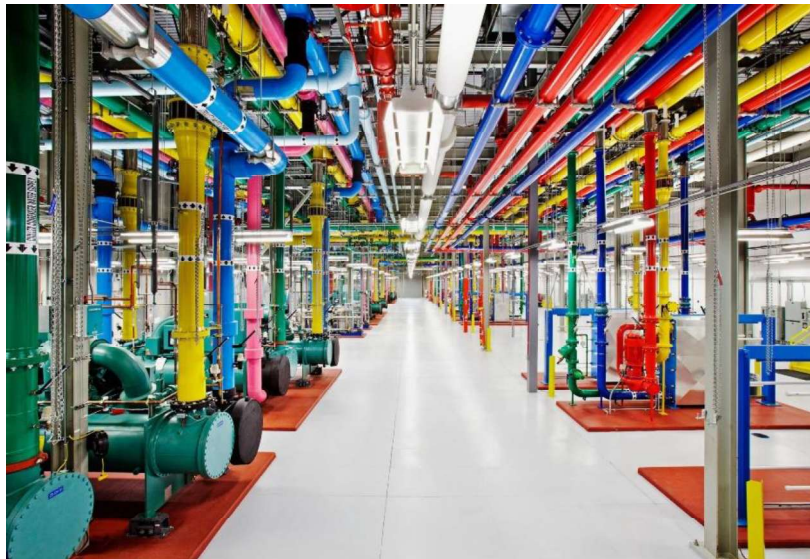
Exemplo de cores das tubulações em planta industrial.
